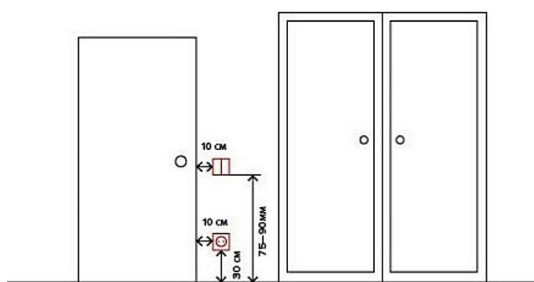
Рекомендуемая схема расположения выключателя и розетки в детской
